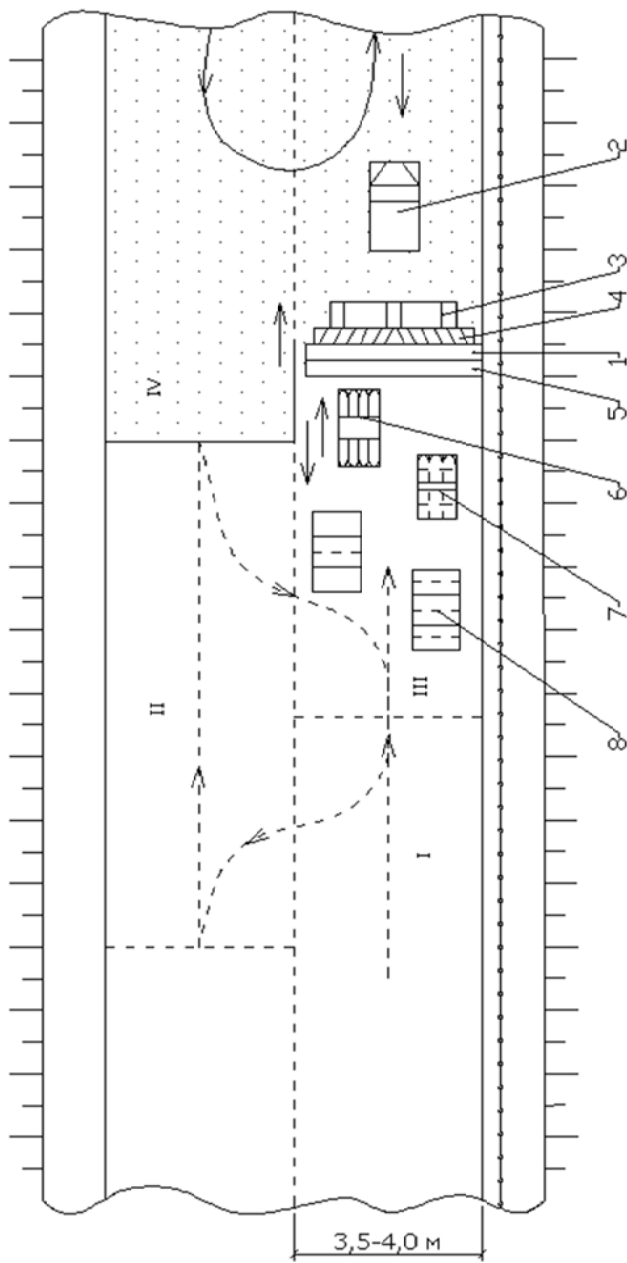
Схема укладки асфальтобетонной смеси одним укладчиком.
